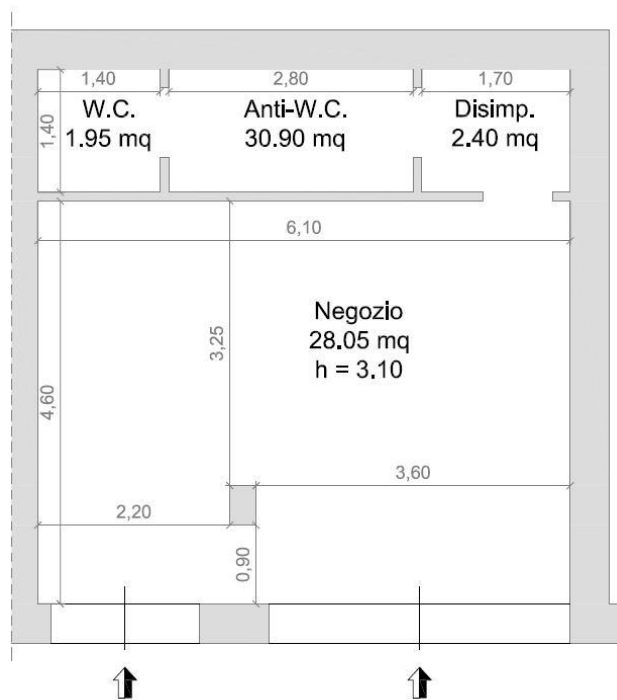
Planimetria Catastale Foglio 29, p.lla 748, sub 11.
